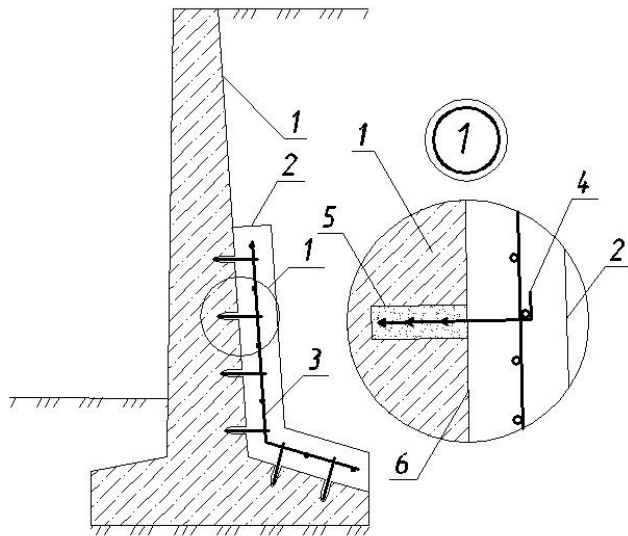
Улаштування залізобетонного нарощування в розтягнутій зоні: 1 – підпірна стінка; 2 – бетонне нарощування в розтягнутій зоні; 3 – робоча арматура сіток; 4 – анкери; 5 – просвердлені отвори; 6 – підготовлена до бетонування поверхня
